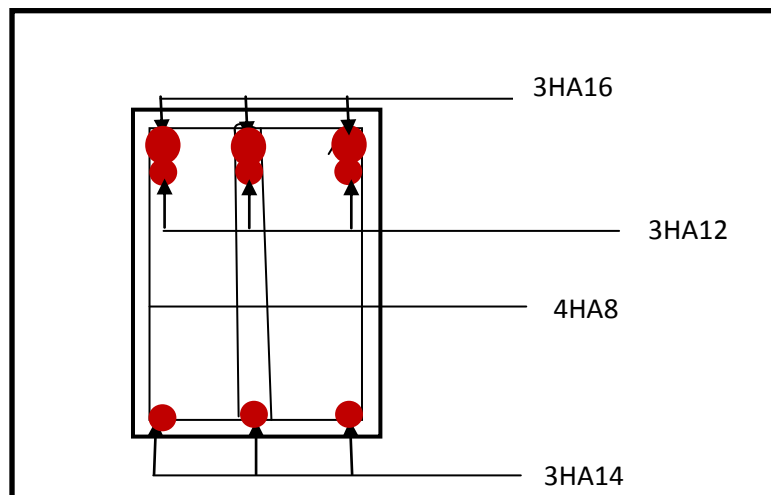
Ferrailage sur appuis d'une poutre principale.
